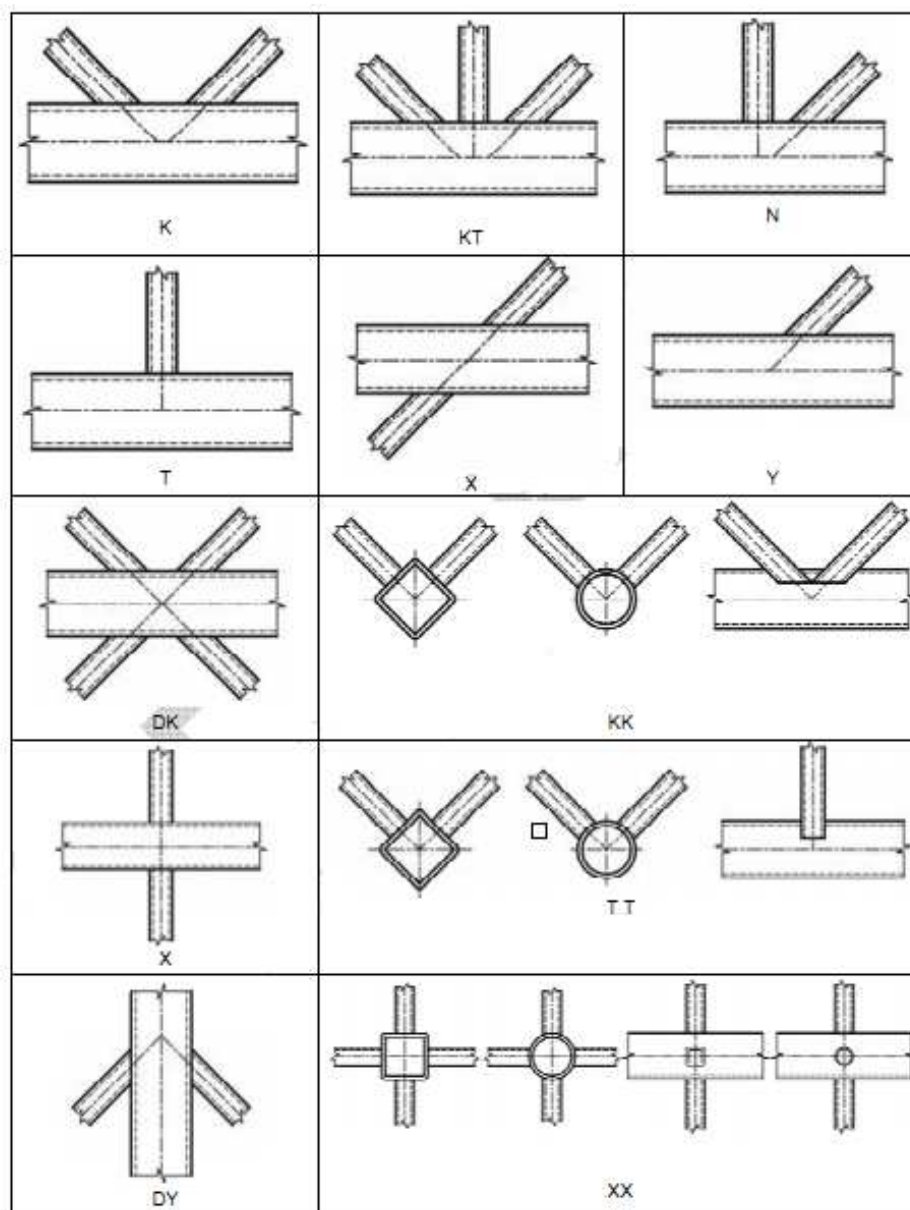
Tipos de ligações soldadas – Adaptada de ABNT NBR Tubos [5]
